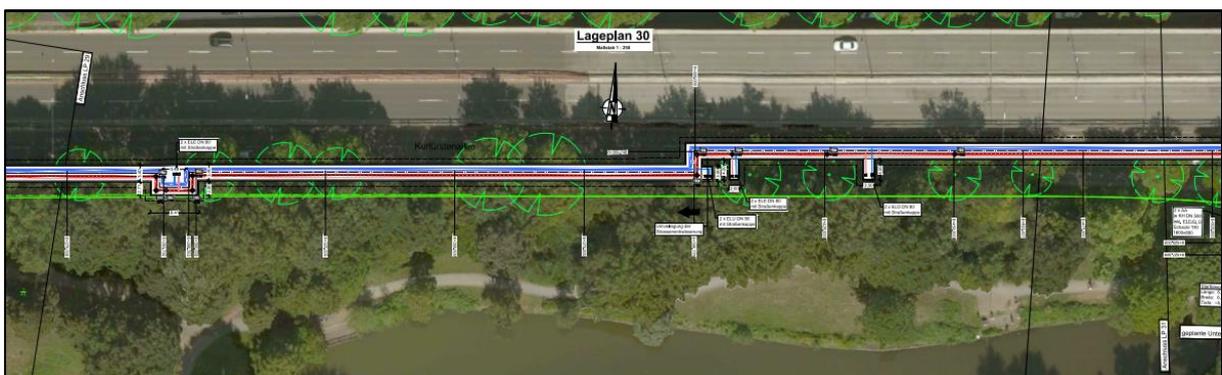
Abschnitt 14 - Kurfürstenallee Plan 2.2.30
